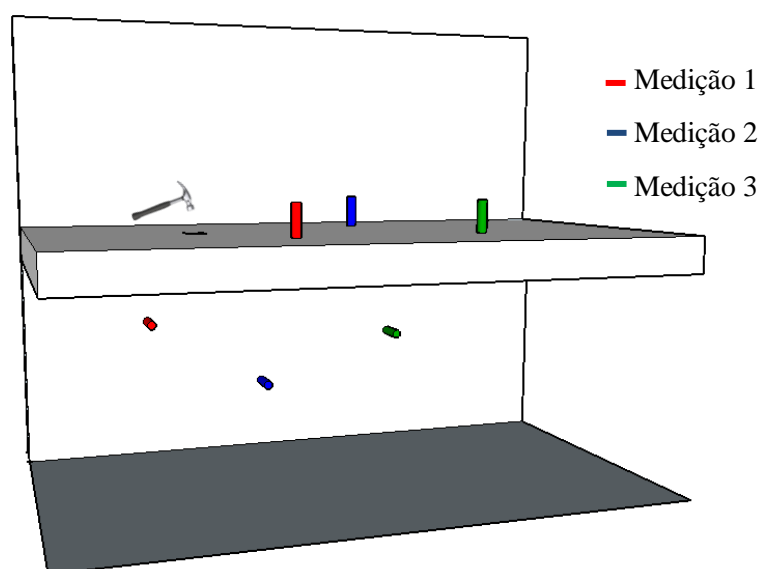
Esquema de ensaio para caracterização do caminho de propagação pavimento/parede piso 1
